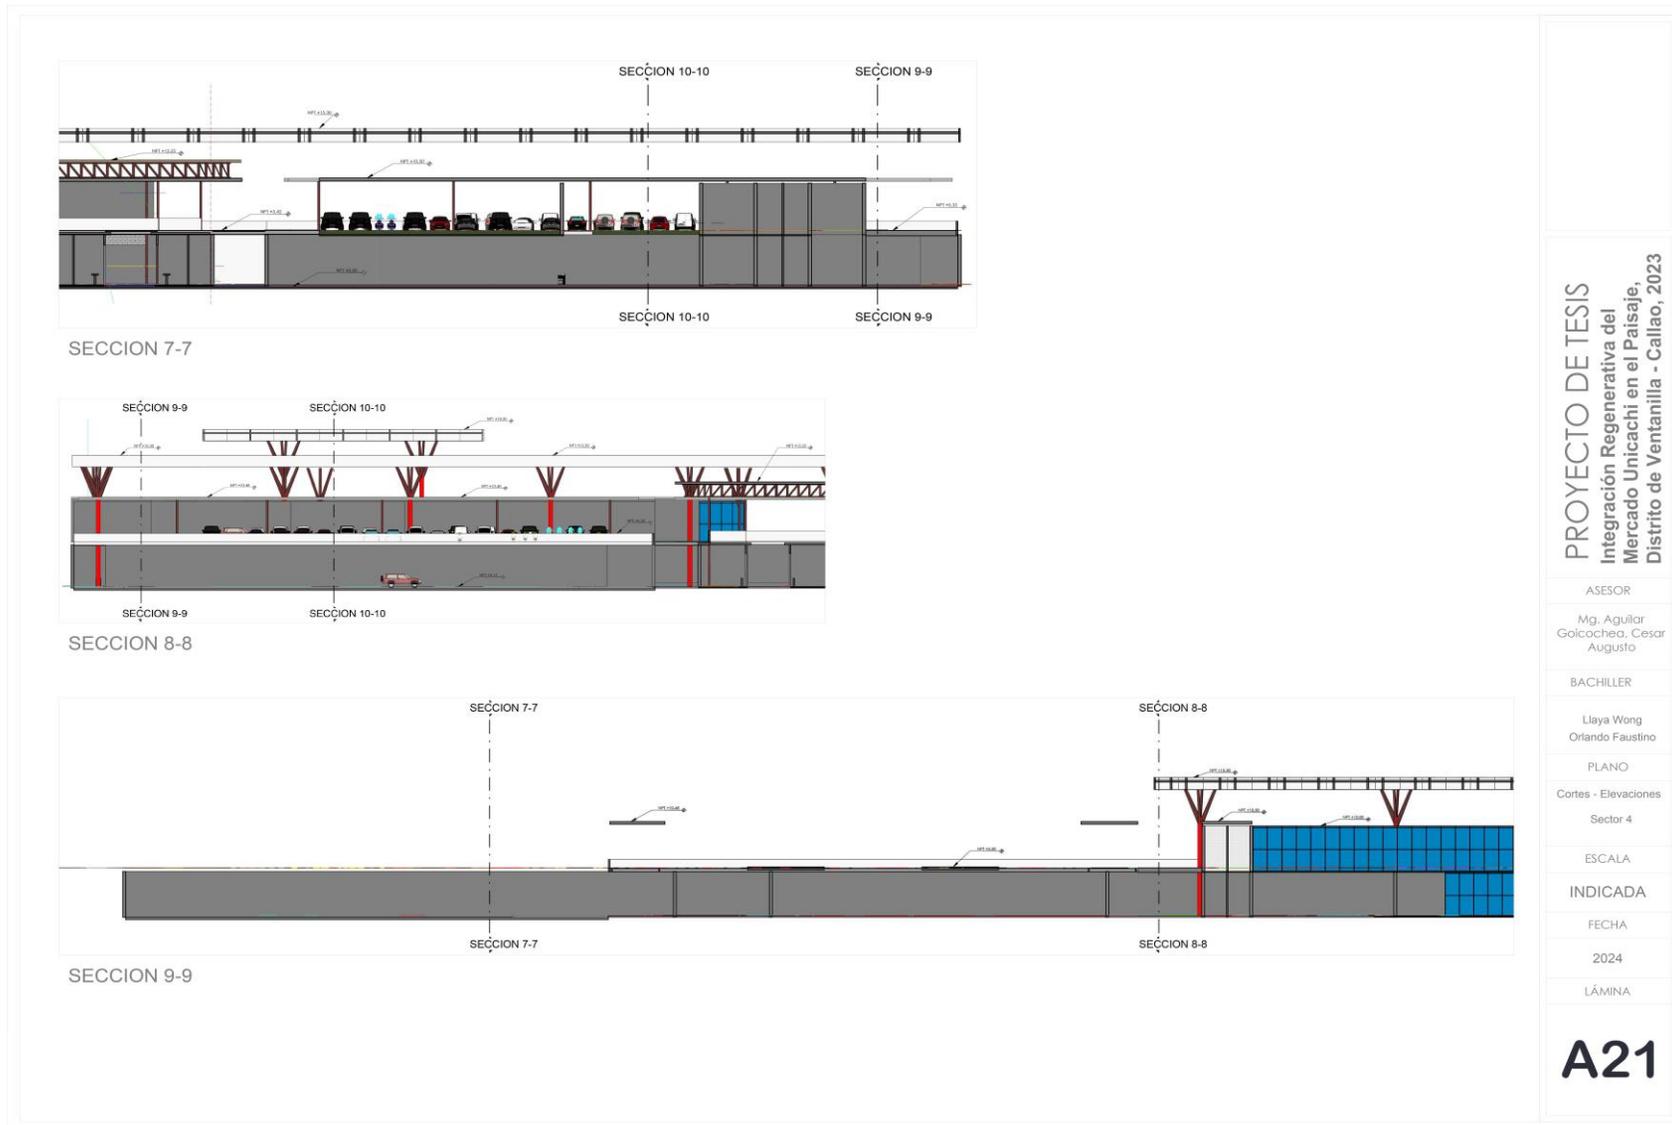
Plano de Cortes elevaciones de sector IV – Plano I, elaboración propia.
